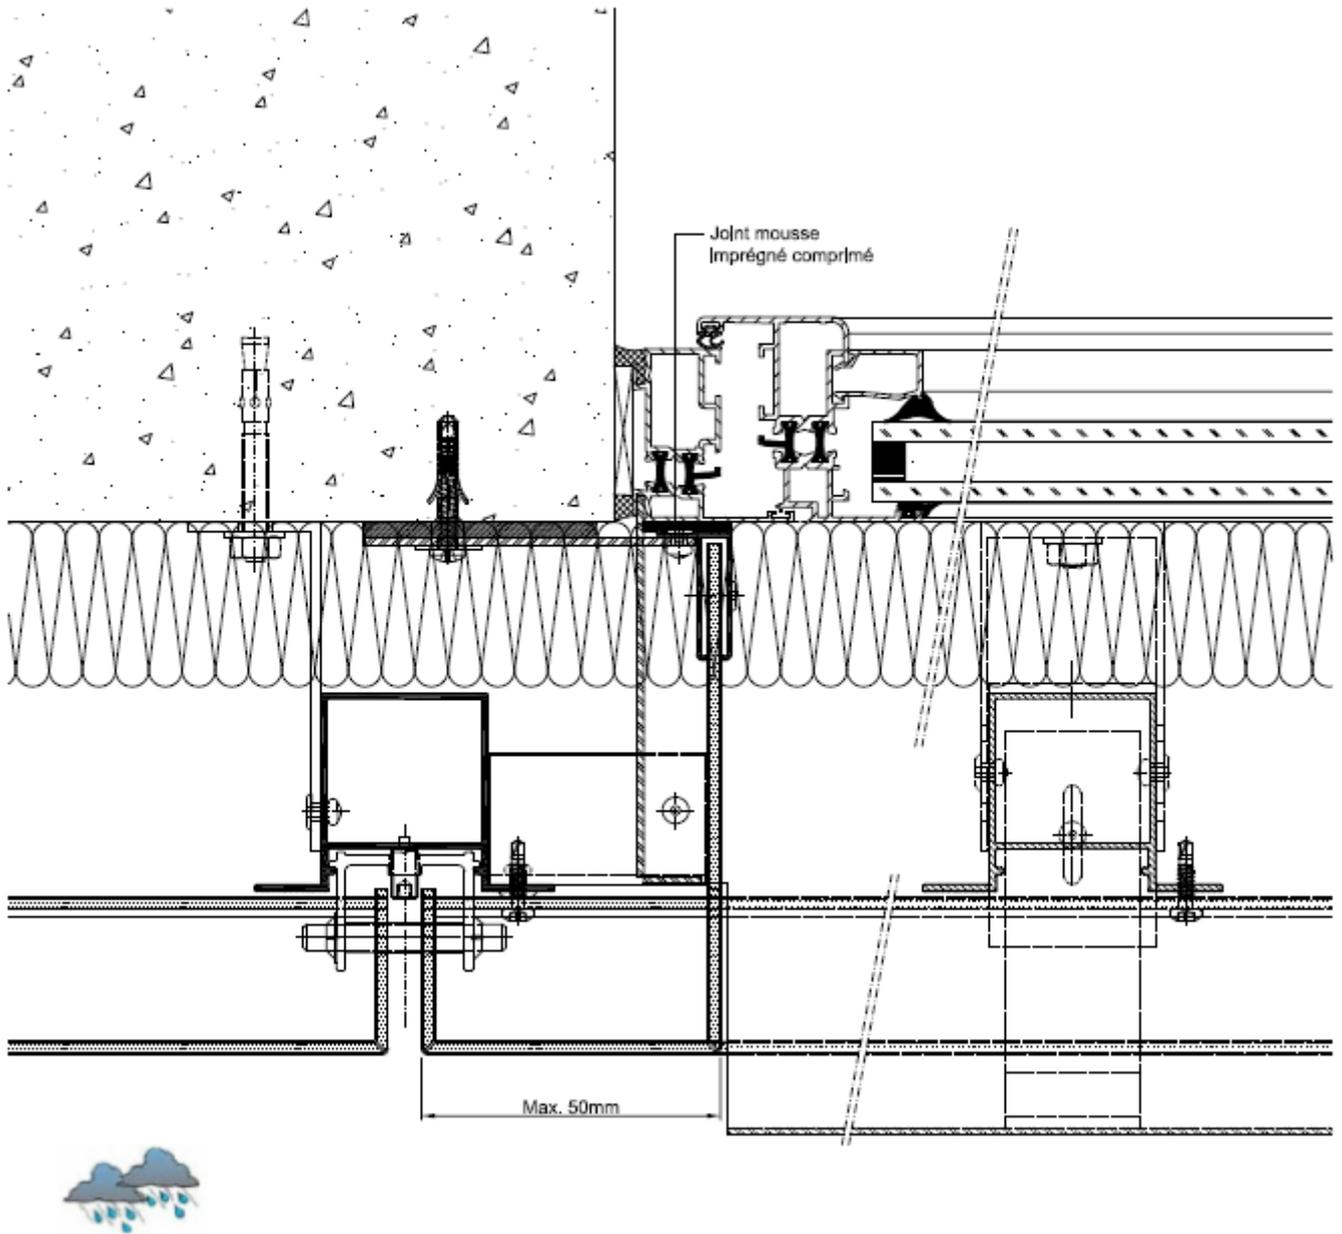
Détail jambage de fenêtre – Coupe horizontale
